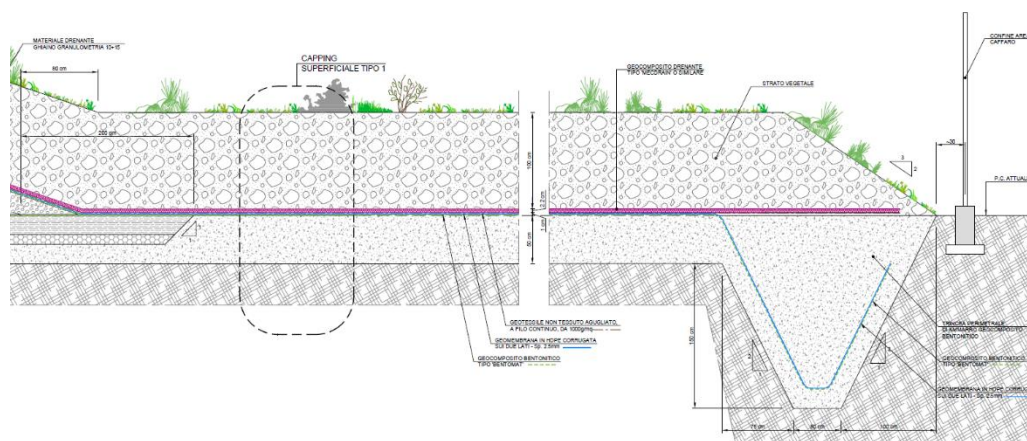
Sezione tipico pacchetto doppia impermeabilizzazione
